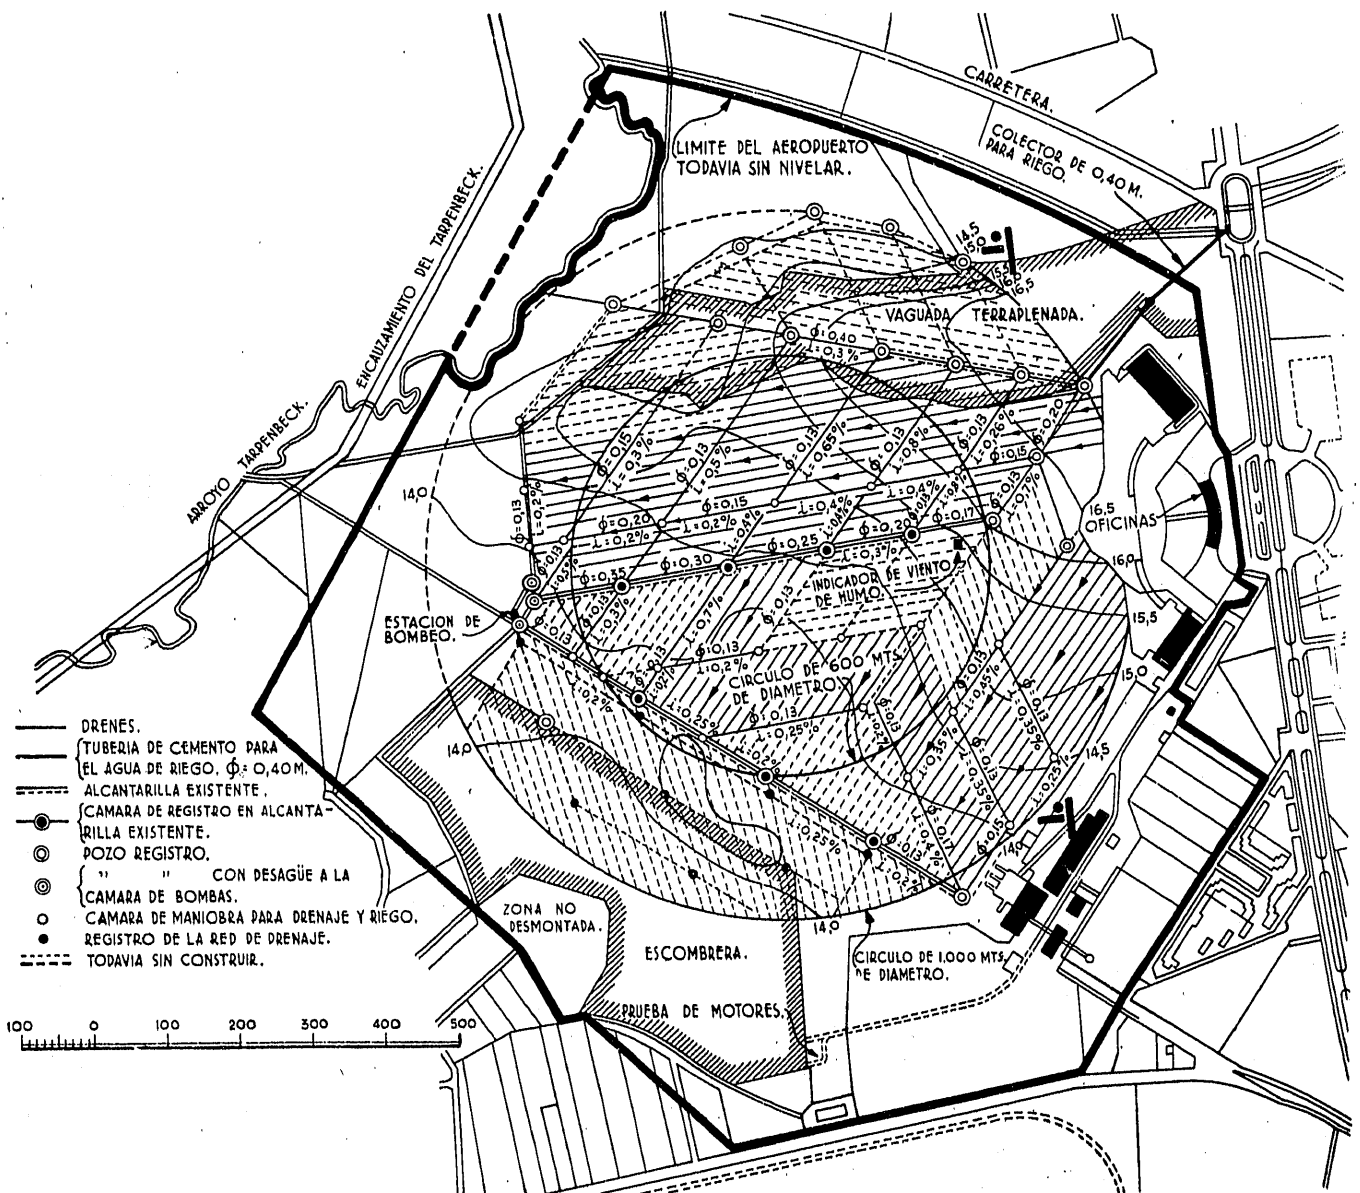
Plano de las redes de drenaje y riego del aeropuerto de Hamburgo.
